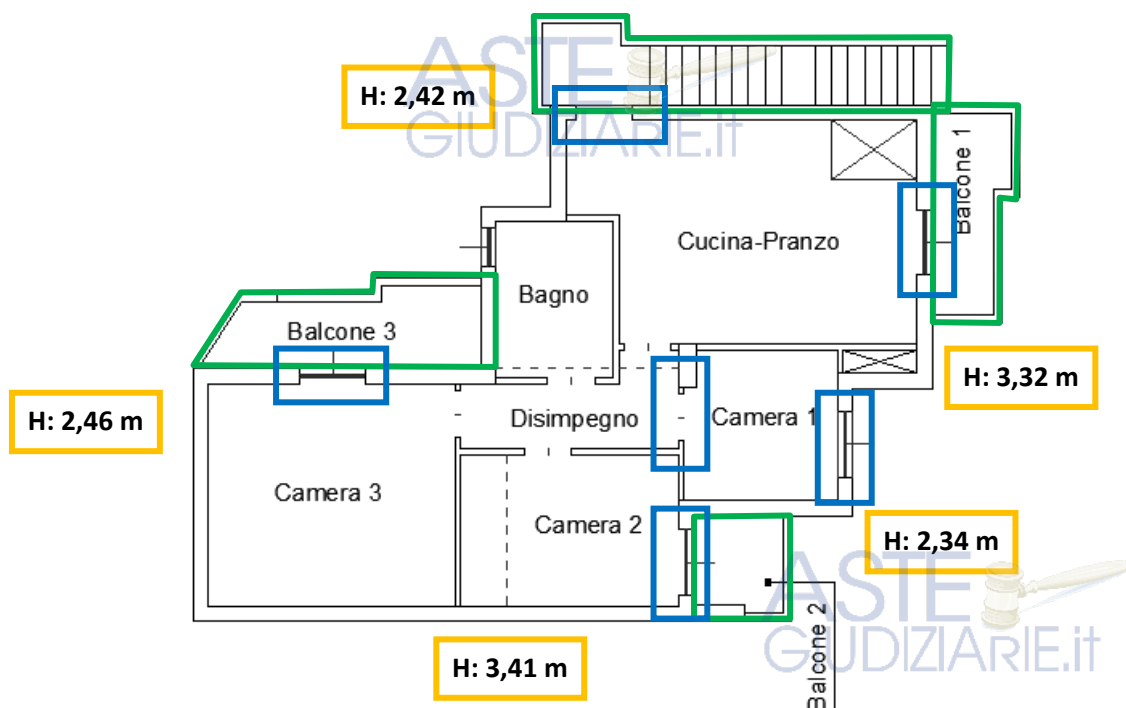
Planimetria stato di fatto con indicazione della sagoma dell'immobile.
